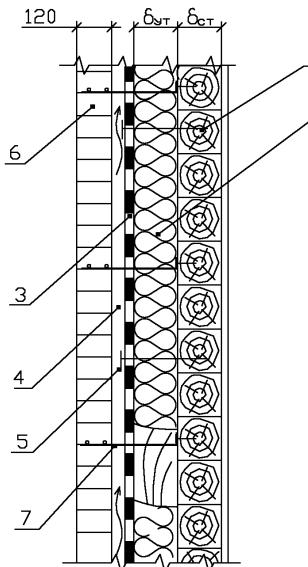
Утепление стены из бревен плитами ИЗОРОК в один слой по деревянному каркасу с облицовкой листовым или плитным материалом в конструкции с вентилируемым зазором.
